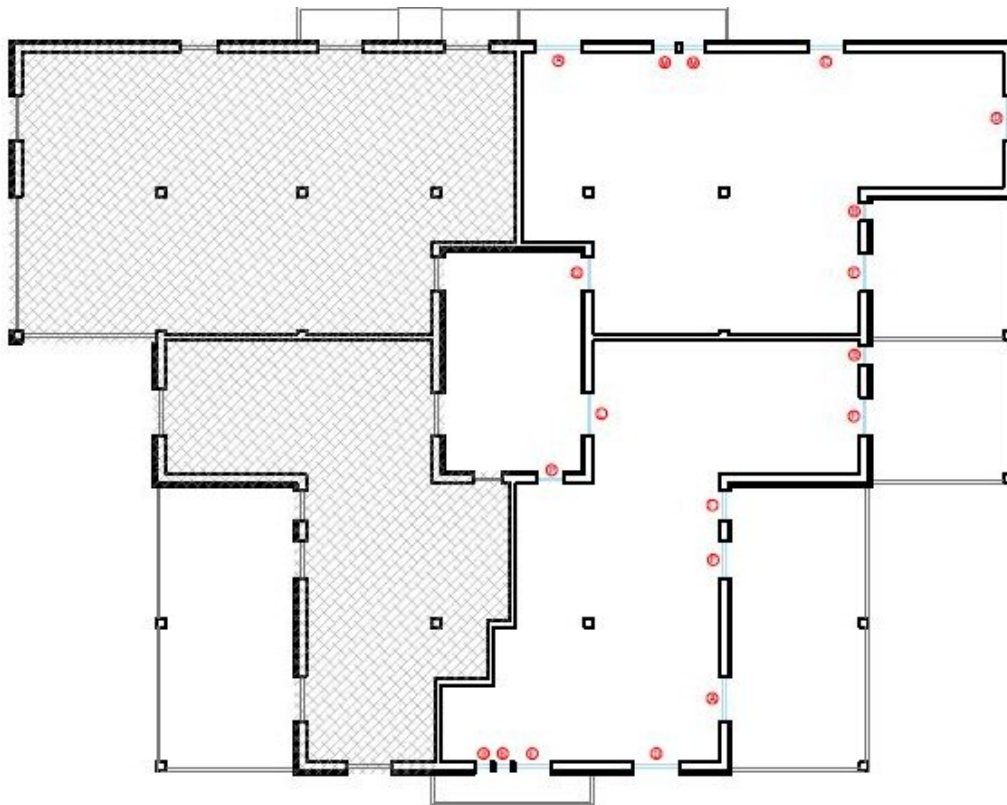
Planimetria infissi da sostituire allegata all'abaco 2
